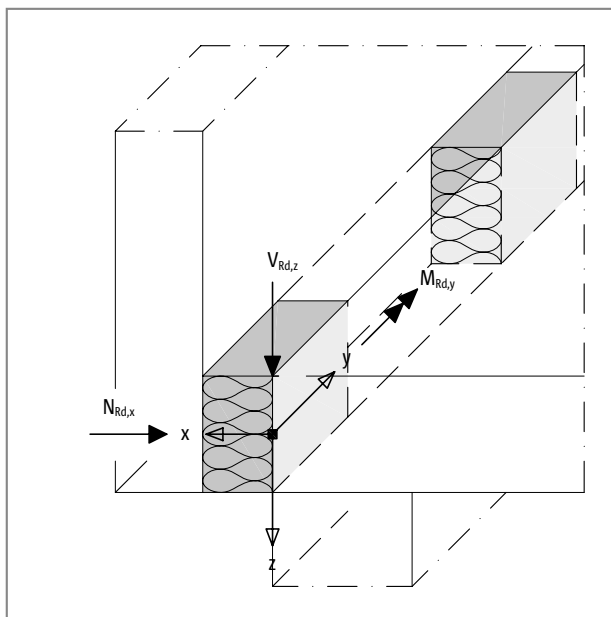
Schöck Isokorb® tipo ABXT: regola dei segni per il dimensionamento di parapetti anteposti
